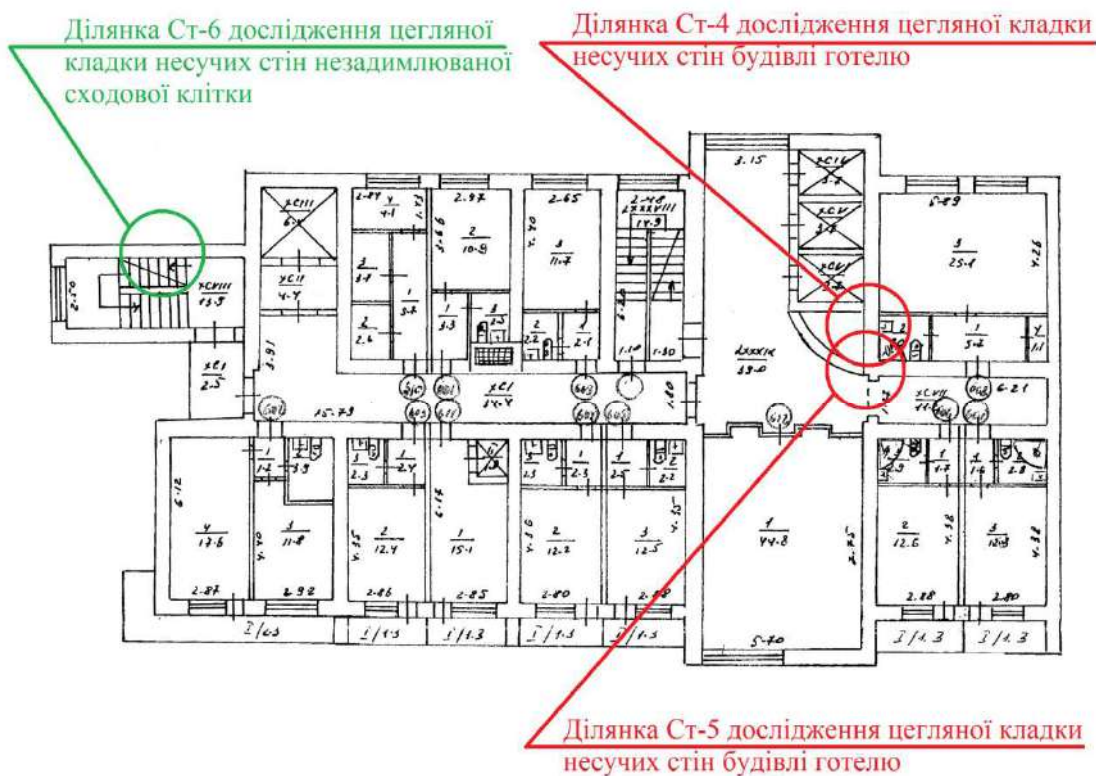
Схема розташування ділянок інструментального обстеження несучих конструкцій 6-го поверху будівлі готелю
